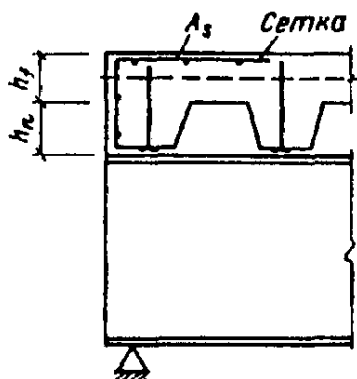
Схема армирования торцовых частей монолитной плиты
